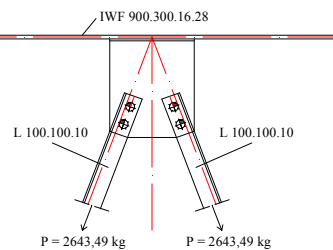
Hubungan Ikiatan Angin Sekunder Bawah Dengan Gelagar Memanjang
